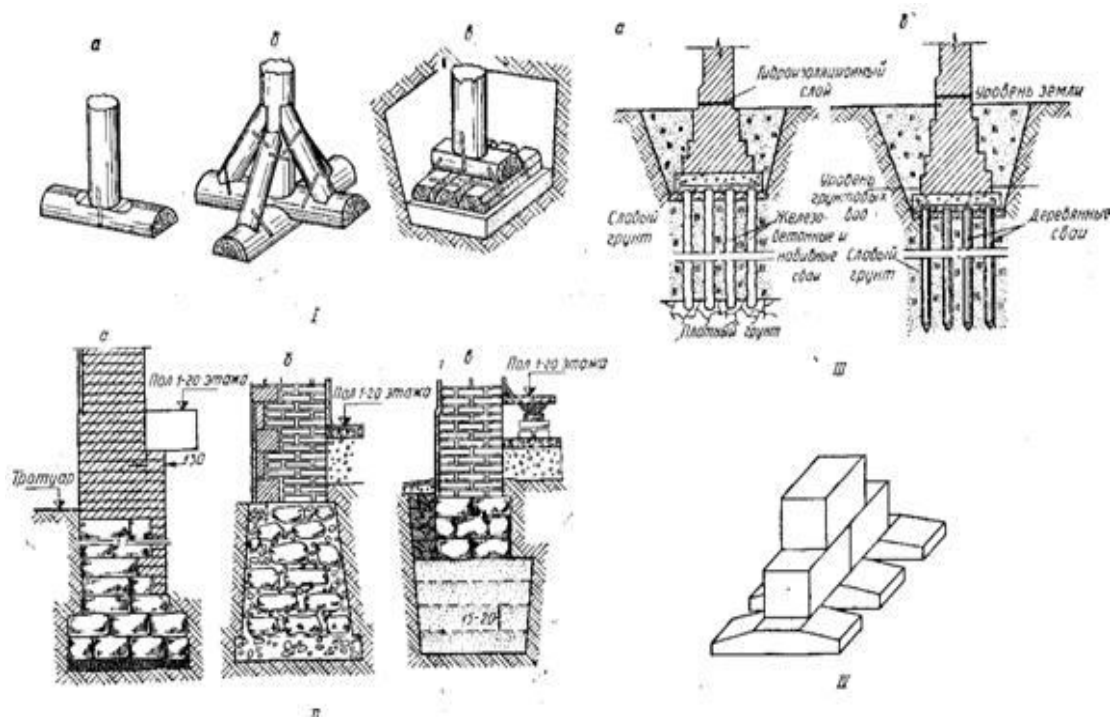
Фундаменты: I – Столбчатые деревянные: а – на пластинчатой подушке, б – на крестовине с подкосами,
